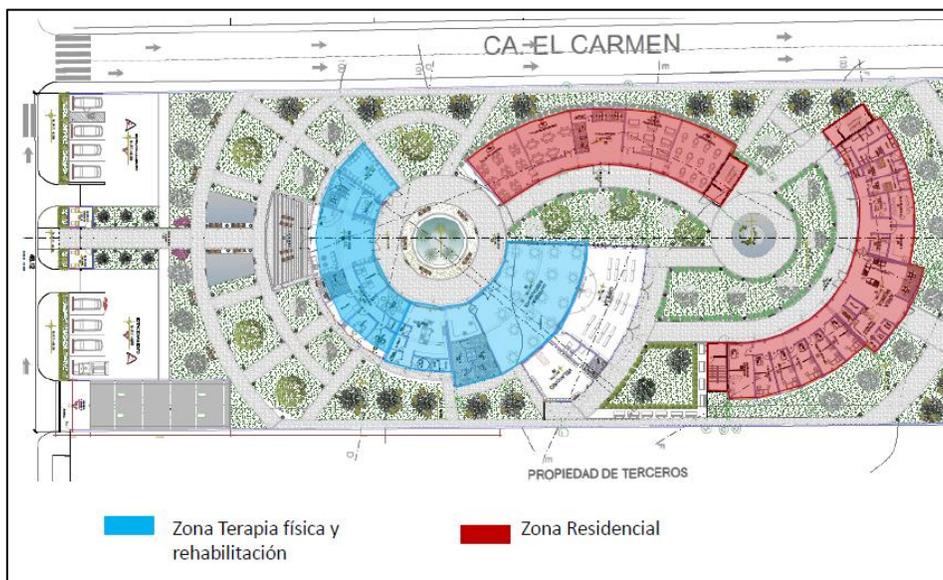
Planimetría general tercer, cuarto, quinto y sexto nivel
